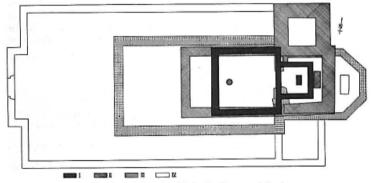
Schema der vier Grundrisse der Kirche St. Peter und Paul.
